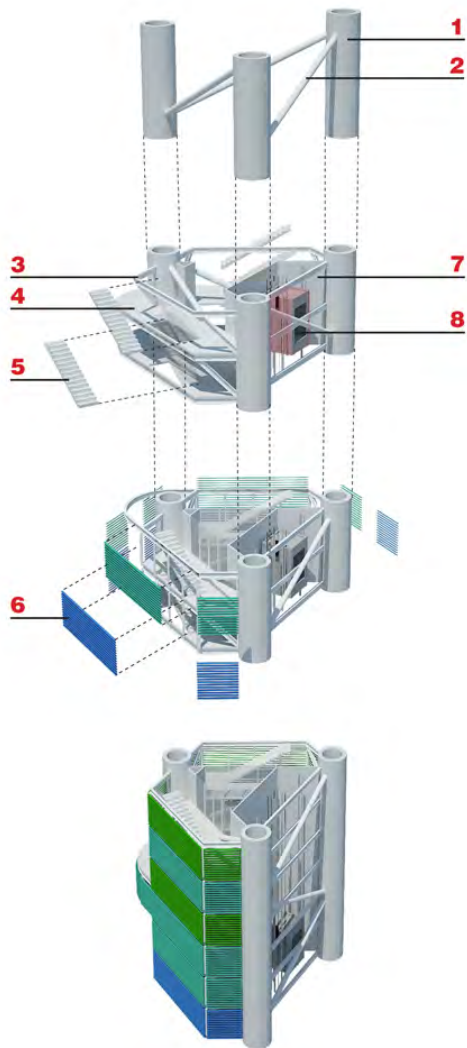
Complexo Rubem Braga, JMBC Arquitetura & Urbanismo, 2010. Legende: (1) Röhrensäule aus Beton, 2m Durchmesser, (2) Stahlgerüst, (3) Stahlbalken, (4) Deck aus Stahlbeton, (5) Stahltreppen, (6) *brise-soleil* aus Legierungsmetall, (7) schussicheres transparentes Glas, (8) verglaste Aufzüge aus Edelstahl, Kapazität 30 Personen (www.ad009cdnb.archdaily.net/wp-content/uploads/2011/12/1324454128-structural-scheme.jpg, 17.11.2013).
